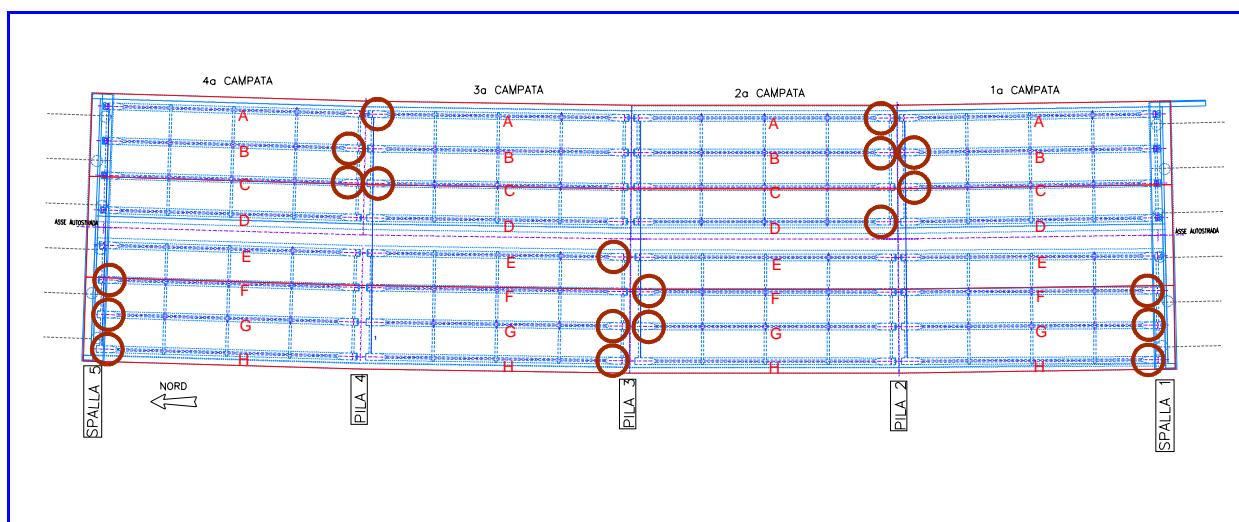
Schema planimetrico del ponte dell'autostrada con ubicazione delle indagini
